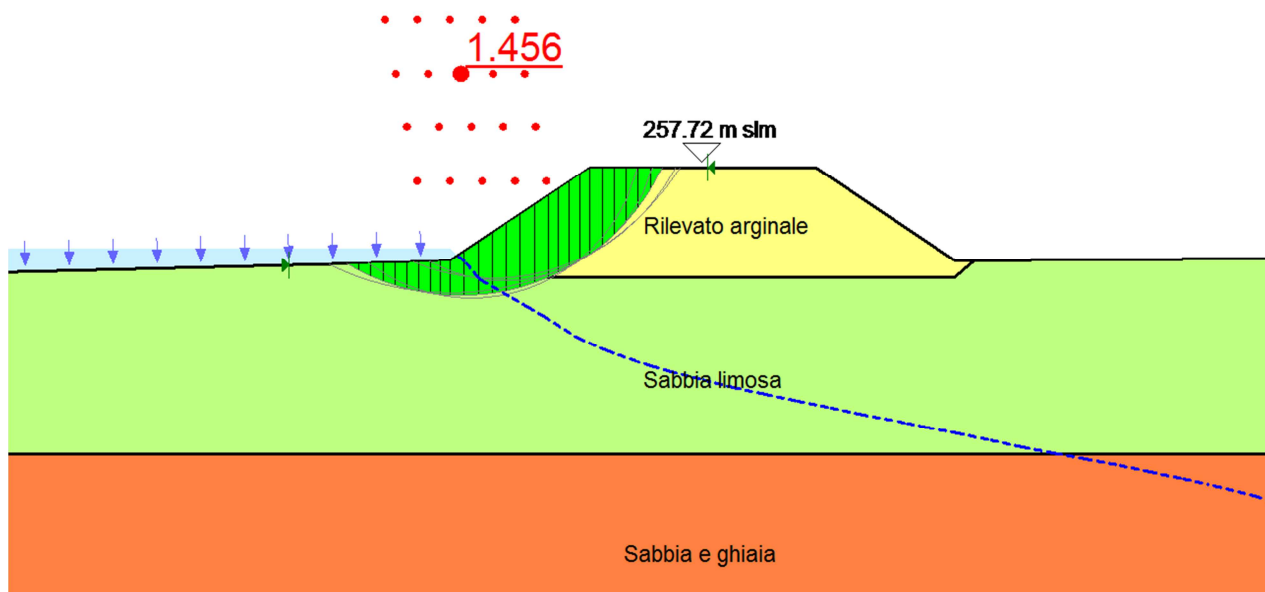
Verifica di stabilità dei paramenti in fase di recessione dell'onda di piena – sezione 7
